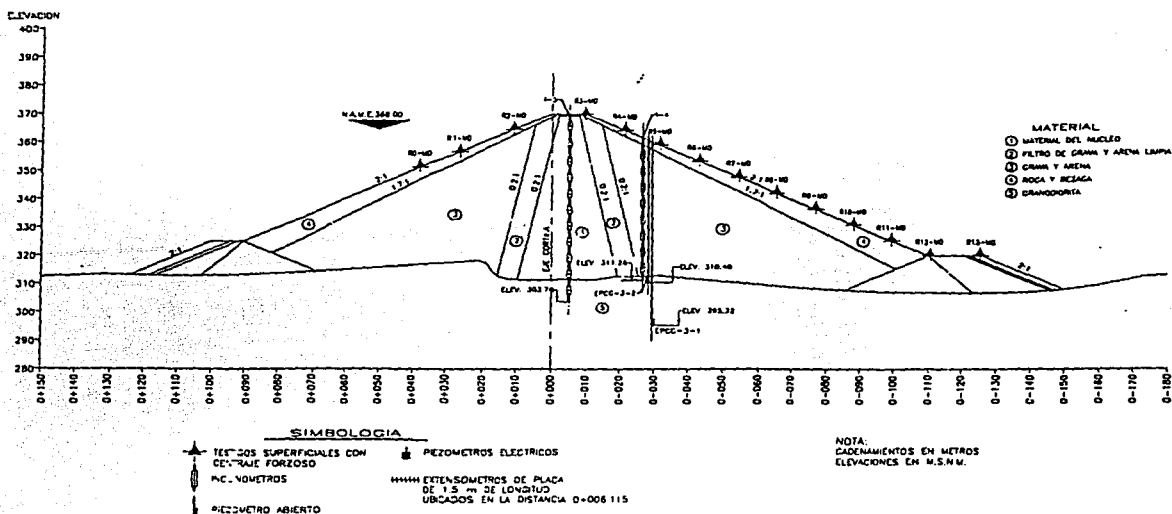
Instrumentación. Sección transversal cadenamiento 0+258.
